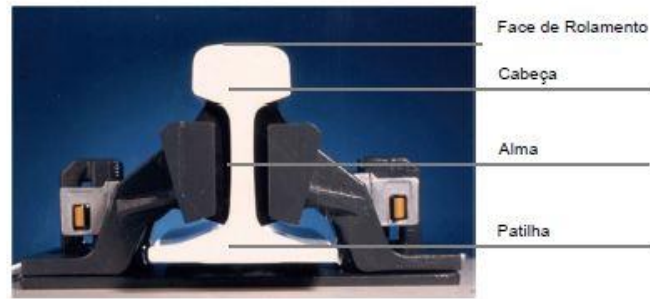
Carril *Vignole* (adaptado de [Paixão & Fortunato, 2009]).
